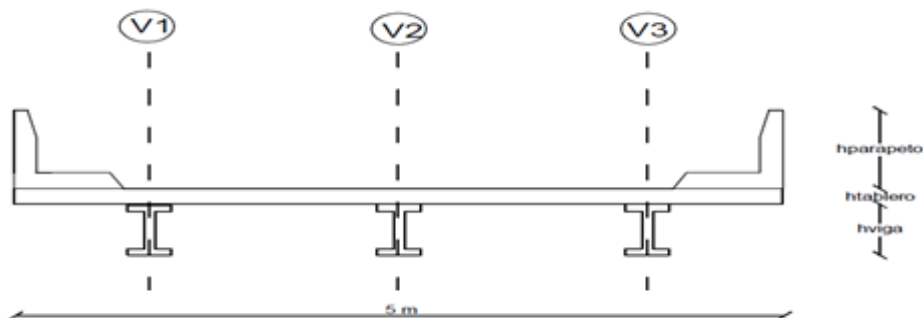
Sección transversal de la superestructura. Elaborado por: El autor.
